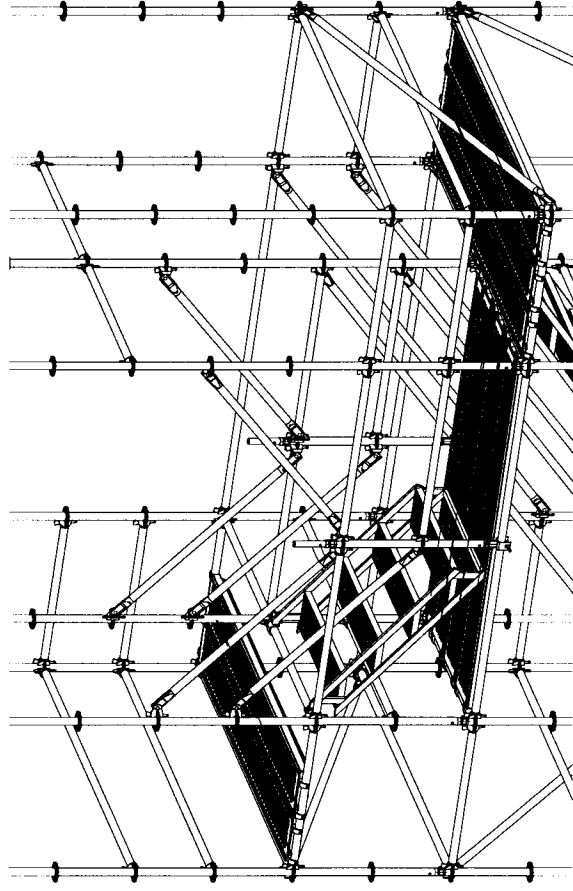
Vorbereitungen zum Einbau der Bautreppe 100
